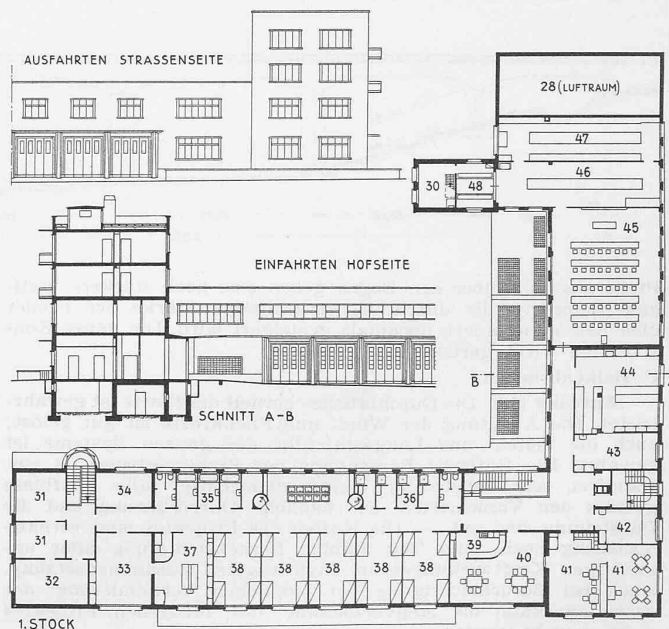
bis 6. Obergeschoss, Schnitt A-B und Fassaden. — 1:600.
